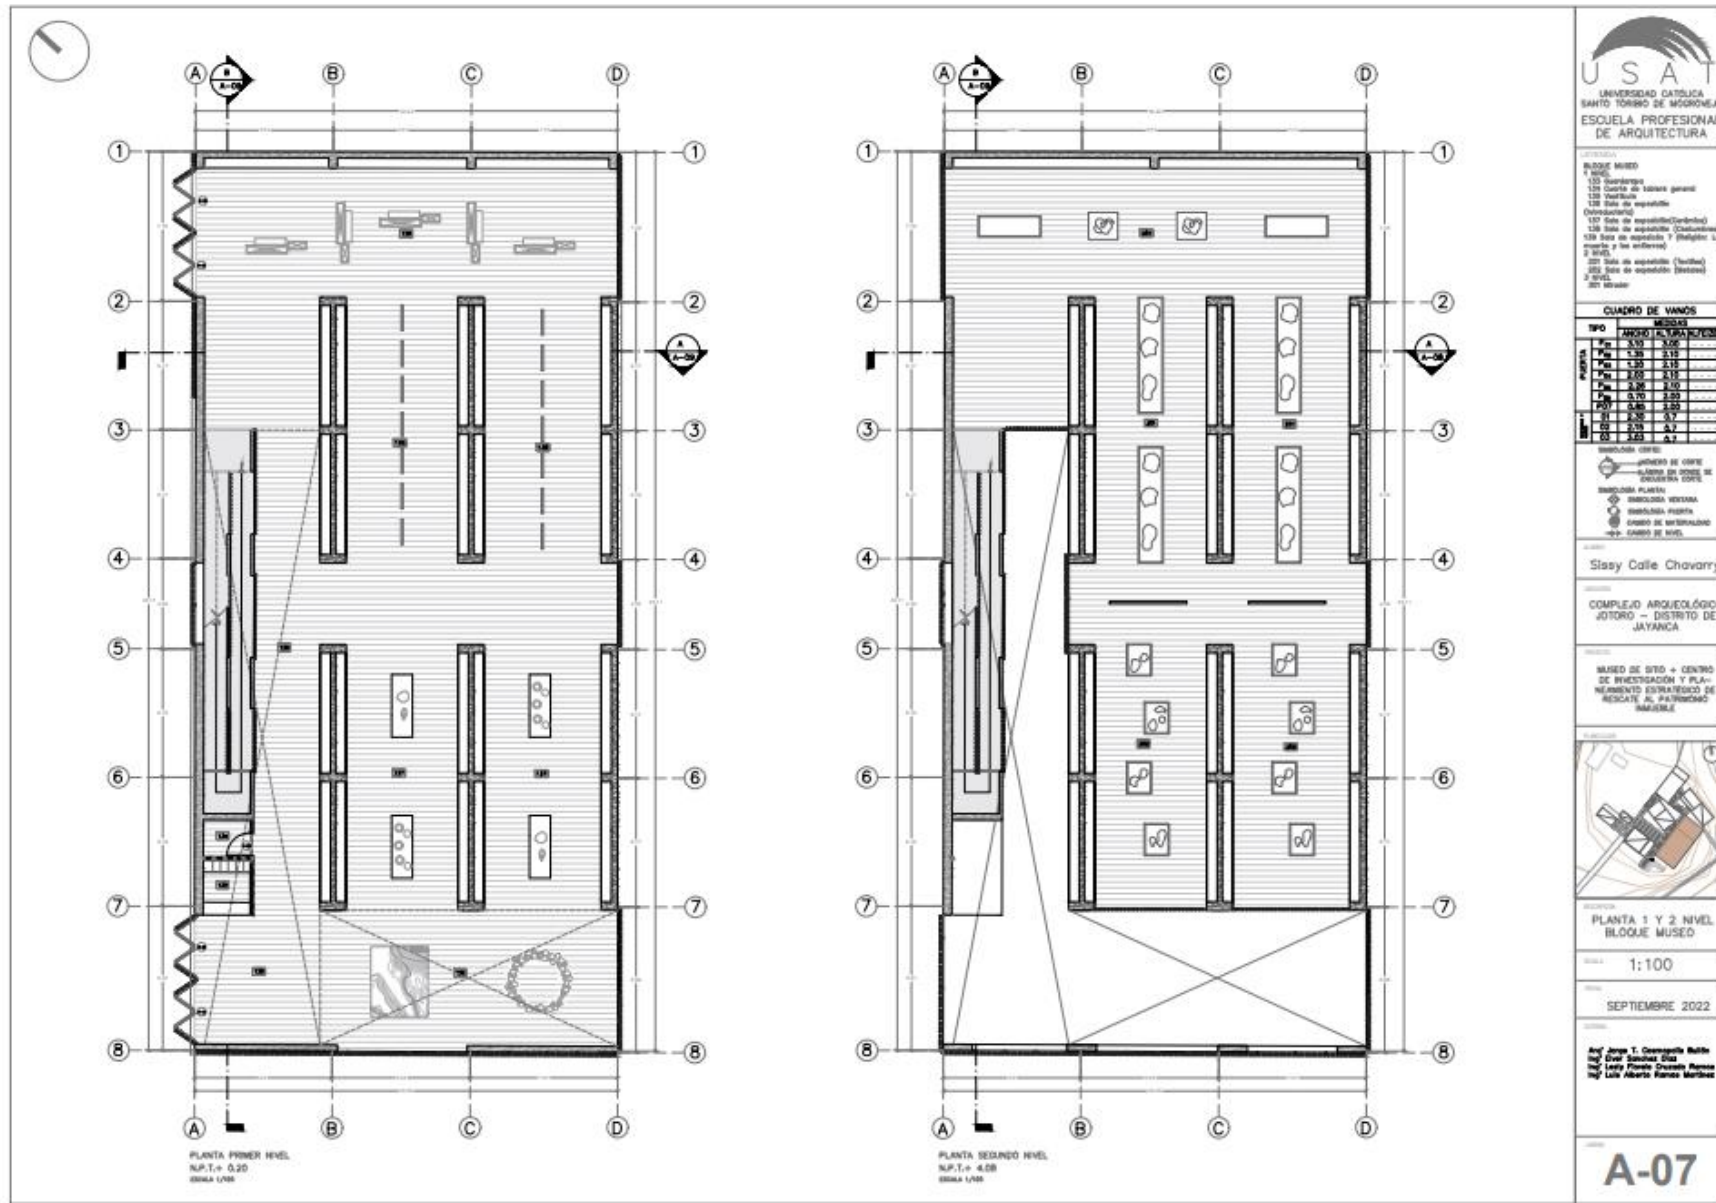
Planos de detalle bloque museo. Fuente: Propia
